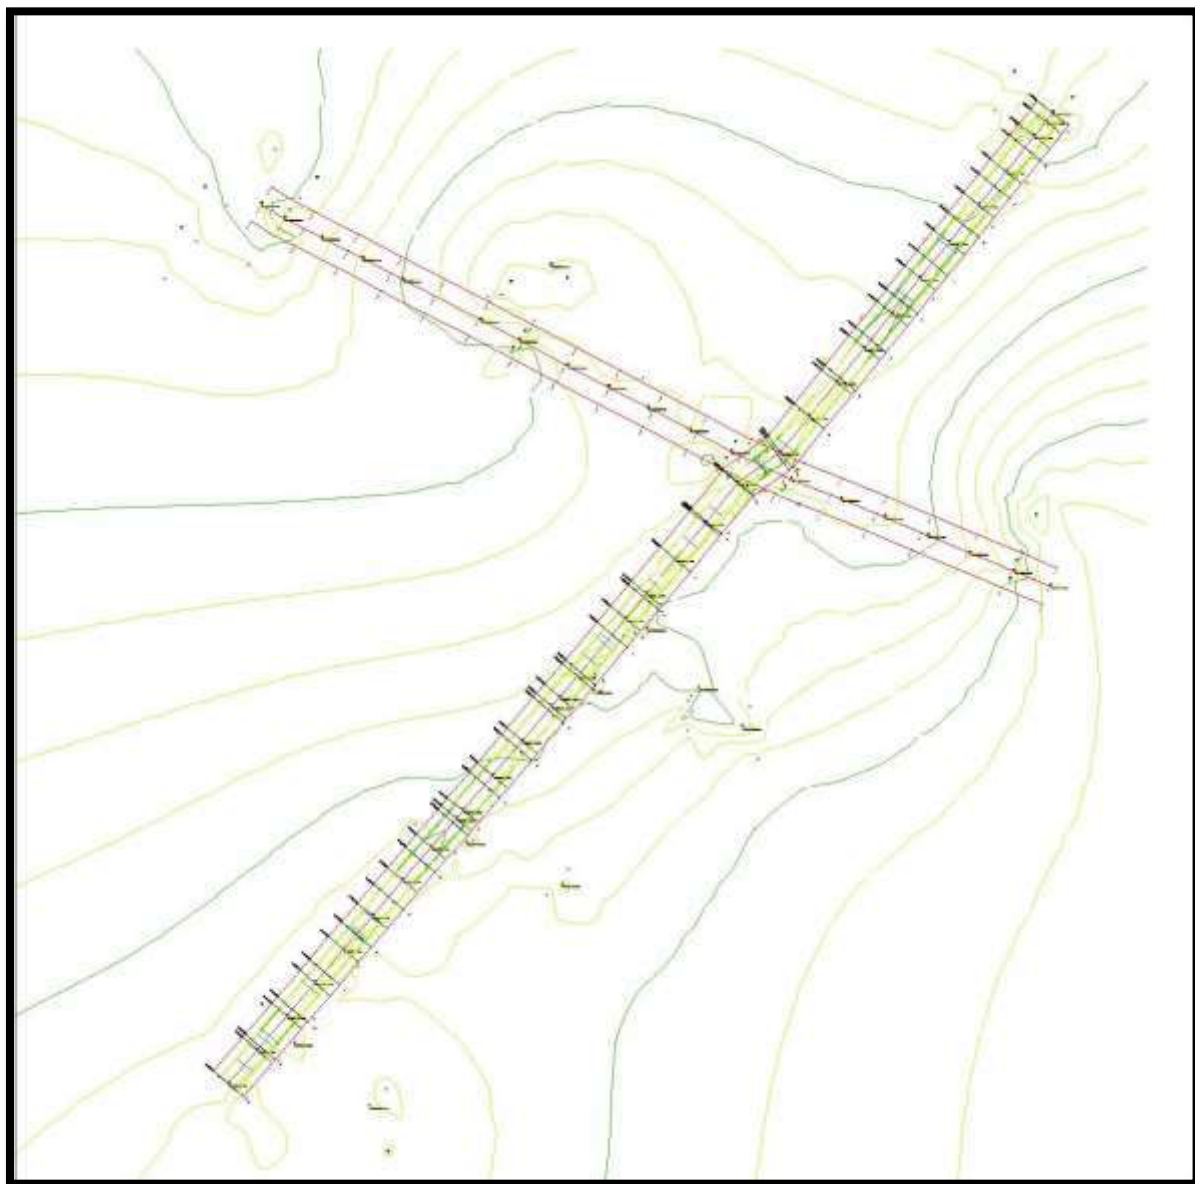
Planimetría procesado en AUTOCAD CIVIL 3D.
